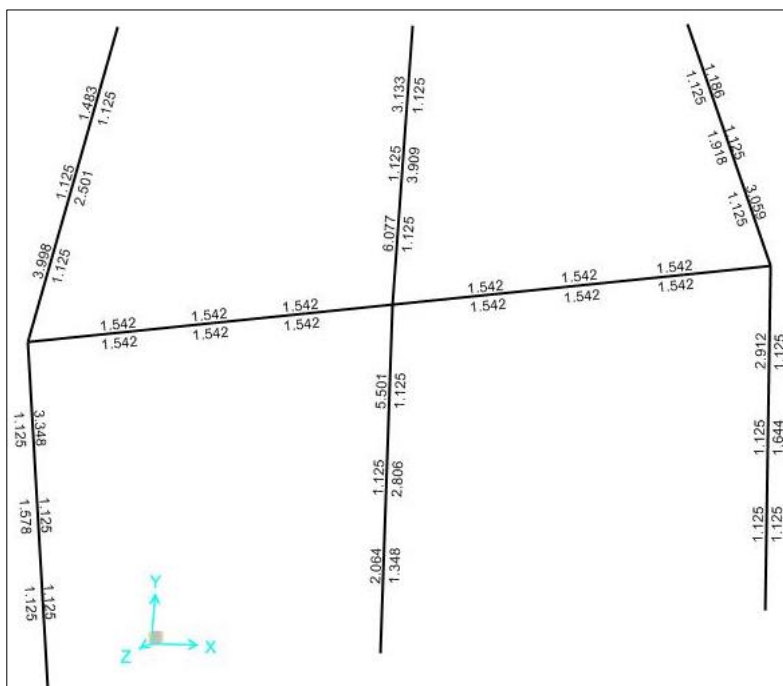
Armadura longitudinal nas vigas de cobertura
